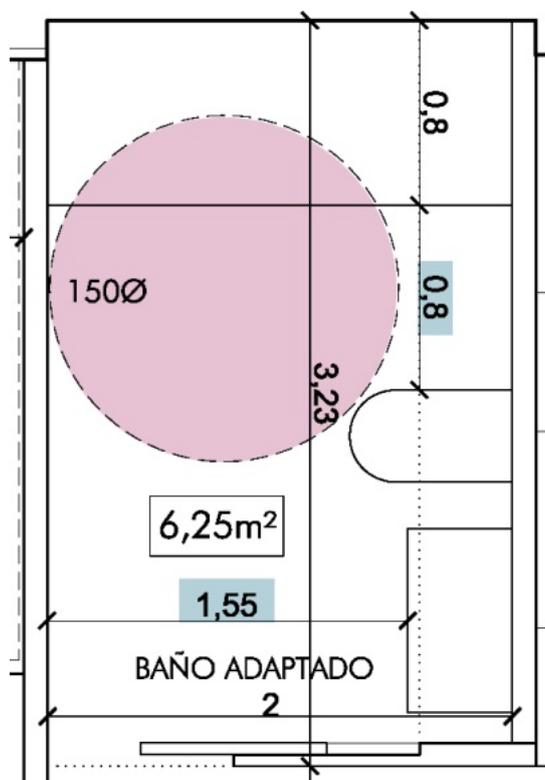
Plano baño adaptado espacio aproximación frontal a lavabo. Fuente propia.
